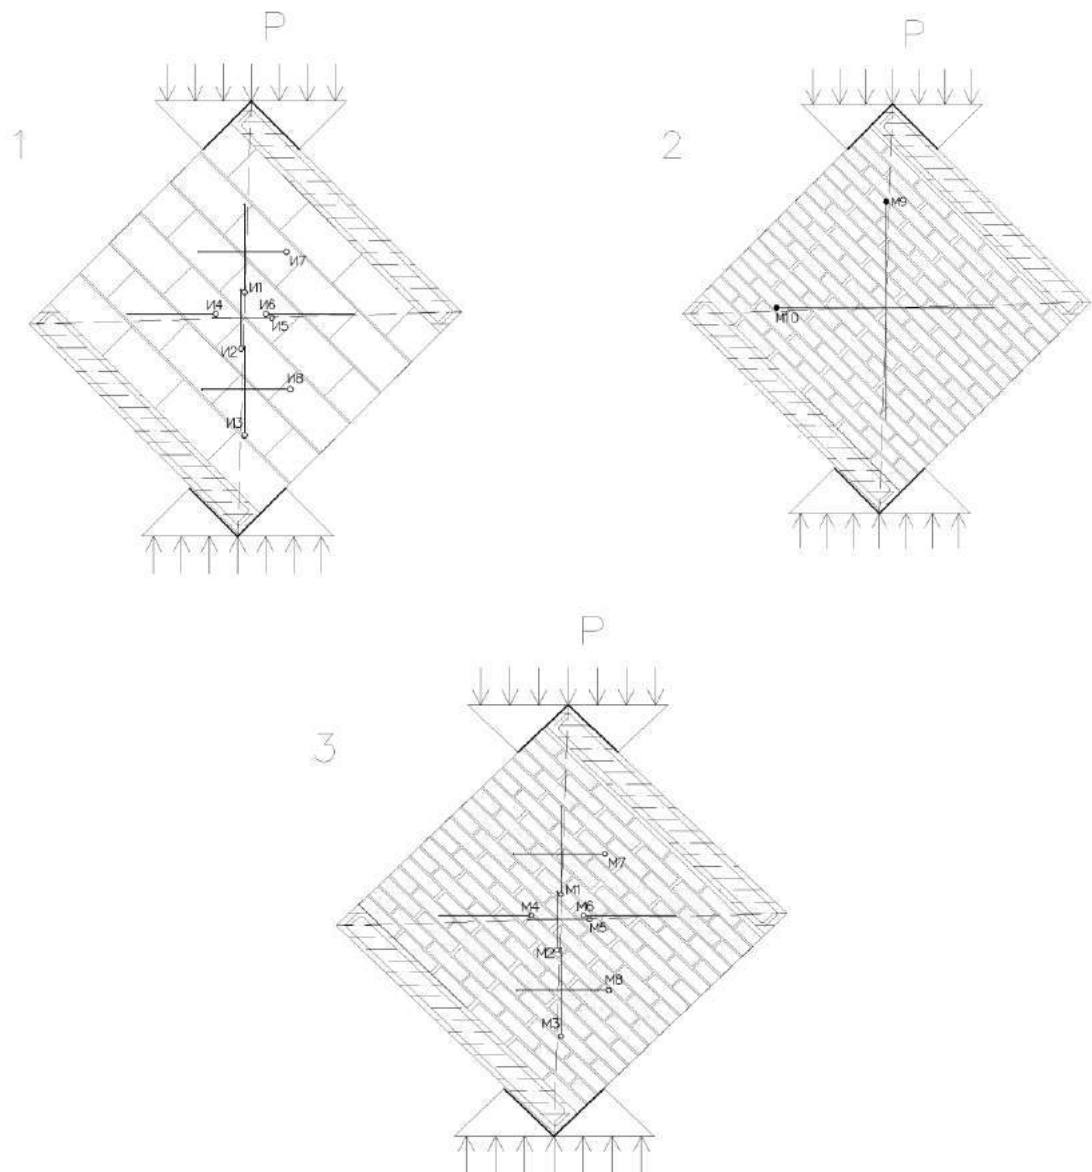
Схема нагружения и расстановки измерительных приборов на трехслойном образце
